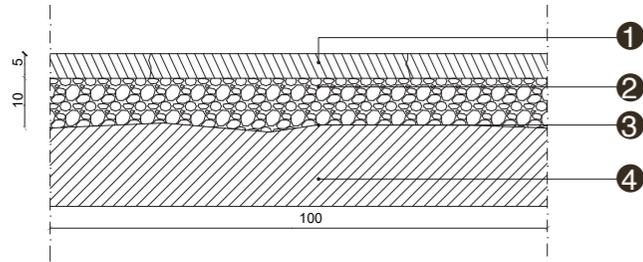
Dettaglio tecnologico pavimento piano Terra. Scala 1:10
